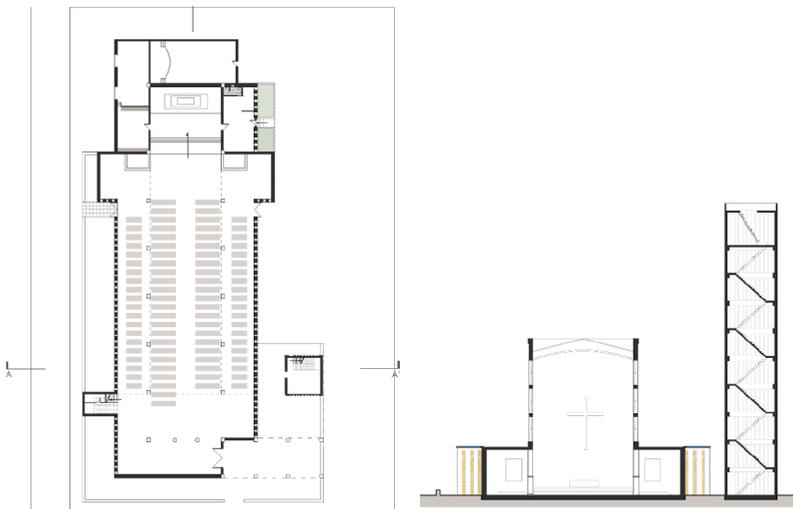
Planteamiento estructural. Despiece volumétrico y áreas del primer piso de la parroquia María Auxiliadora
